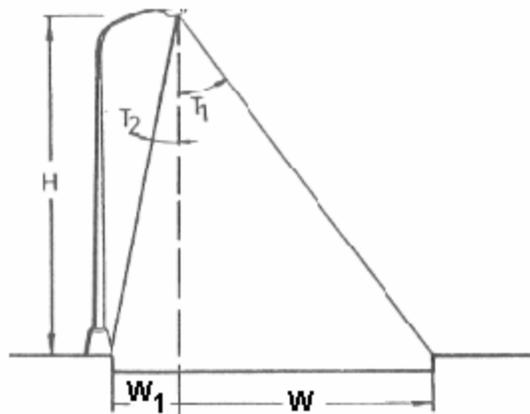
Detalle de estructura para alumbrado perimetral⁵
